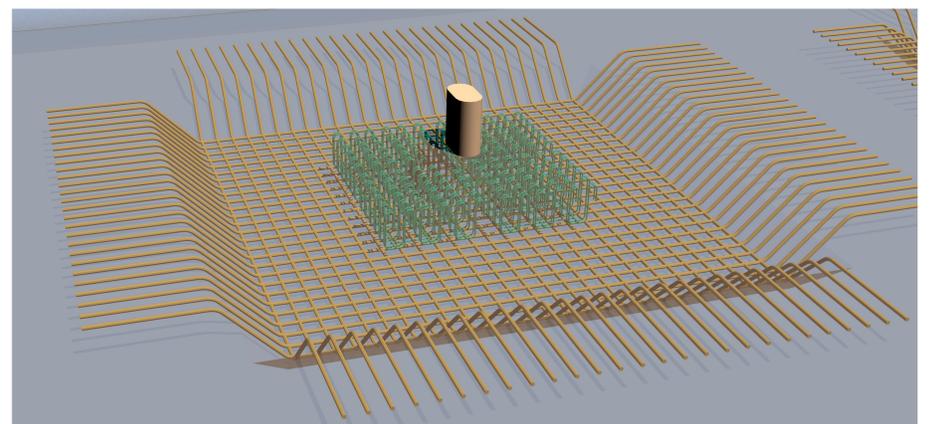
untere Bewehrung eines Fundaments mit Durchstanzbewehrung
